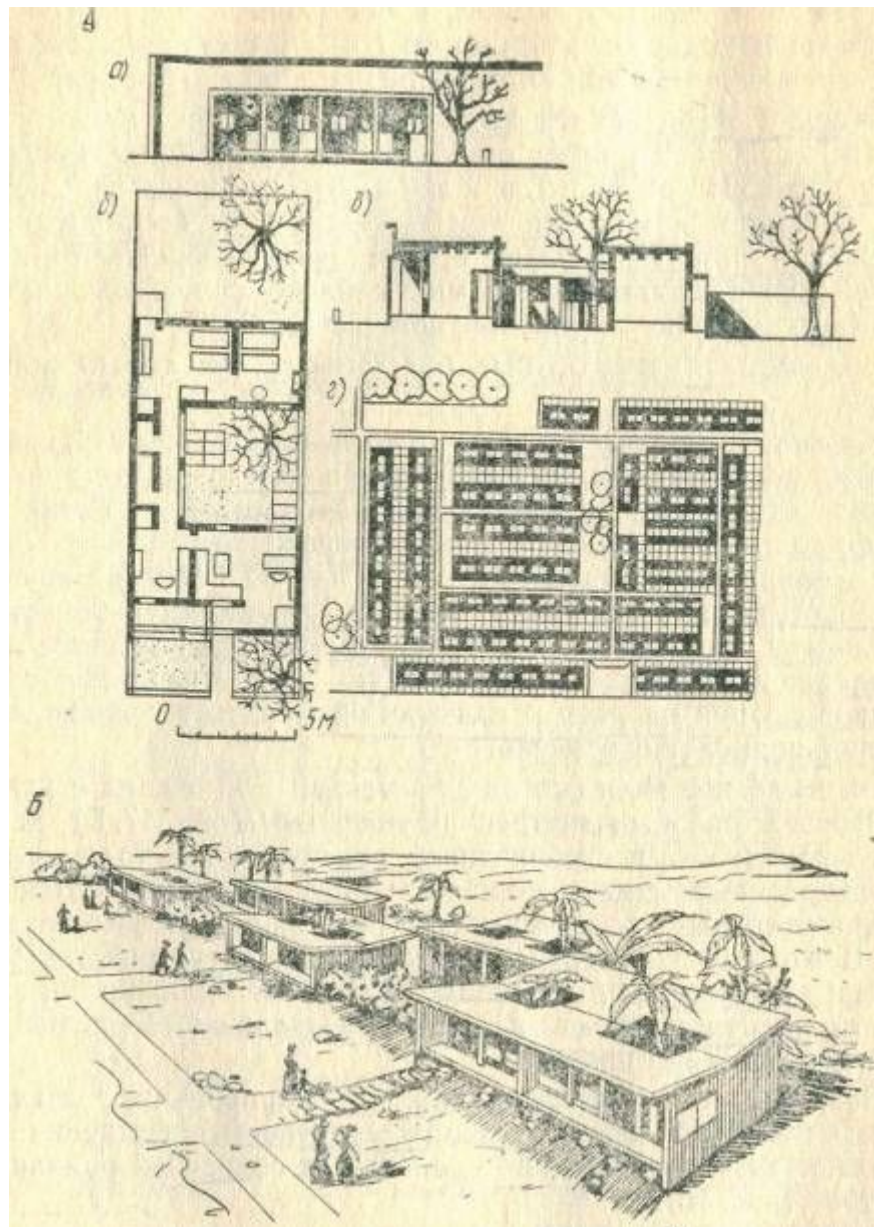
Малоэтажные дома с внутренними дворами: А — поселок для сельскохозяйственных рабочих в Чандигархе (Индия): а — фрагмент фасада; б — план дома; в — разрез; г — генеральный план; Б — типовой проект жилых домов для Антильских островов.
